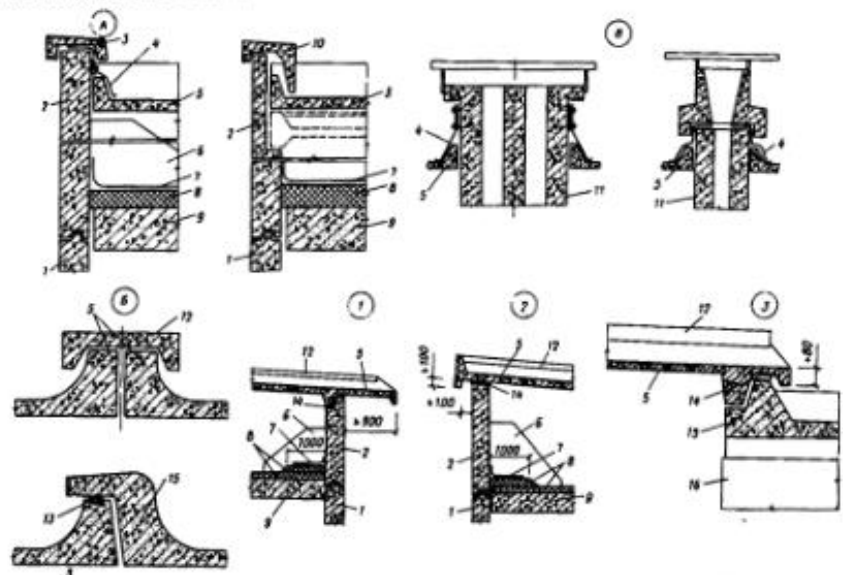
Узлы сопряжений безрулонной крыши с холодным чердаком (тип Б): А – варианты сопряжений крыши с торцевой наружной стеной; Б – варианты продольных стыков кровельных панелей; В – варианты конструкций сопряжений вентиляционных шахт с крышей; 1 – панель наружной стены; 2 – фризровая панель торцевой стены; 3 – паралетная плита; 4 – фартук из оцинкованной стали; 5 – кровельная панель; 6 – опорный элемент фризовой панели; 7 – полоса рубероида; 8 – утеплитель; 9 – плита чердачного перекрытия; 10 – Г-образный паралетный элемент; 11 – вентиляционная шахта; 12 – нащельник; 13 – герметик; 14 – цементный раствор; 15 – водосборный лоток; 16 – опорный элемент лотка
